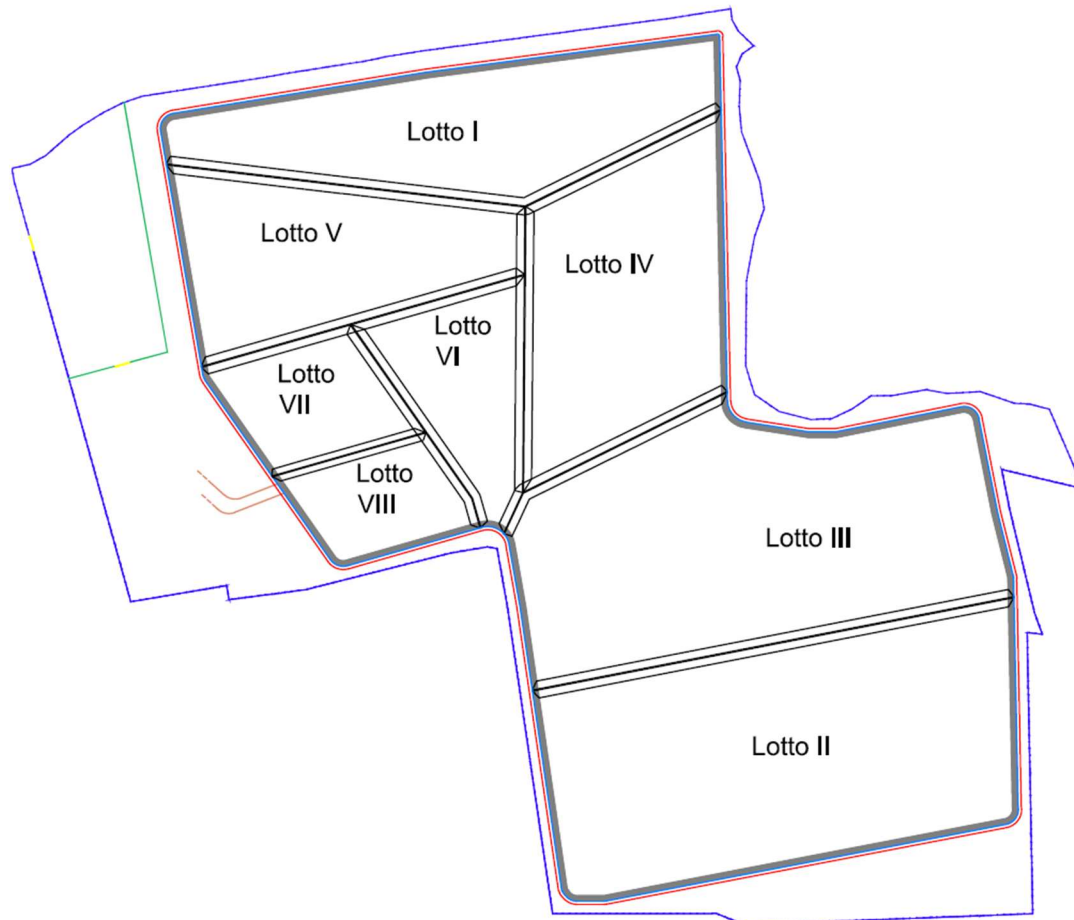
Planimetria Operativa della Discarica – Cava La Bolla
